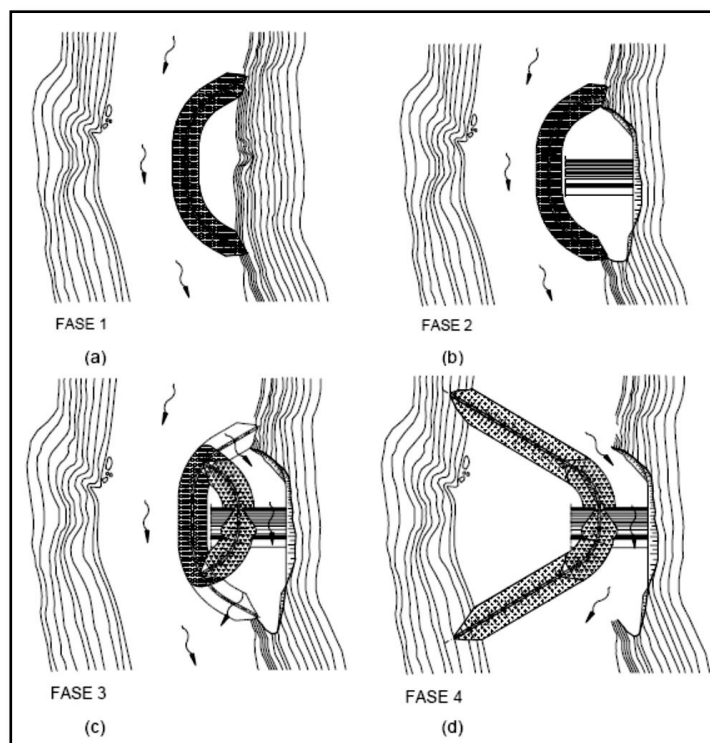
Desvio provisório com ensecamento parcial do leito do rio: (a) Fase 1- construção da ensecadeira; (b) Fase 2- Construção do primeiro troço da barragem; (c) Fase 3- Construção de parte da ensecadeira de 2ª fase e remoção parcial da de 1ª fase; (d) Fase 4- Conclusão da ensecadeira de 2ª fase e remoção do troço restante da de 1ª fase (Pinheiro, 2002).
